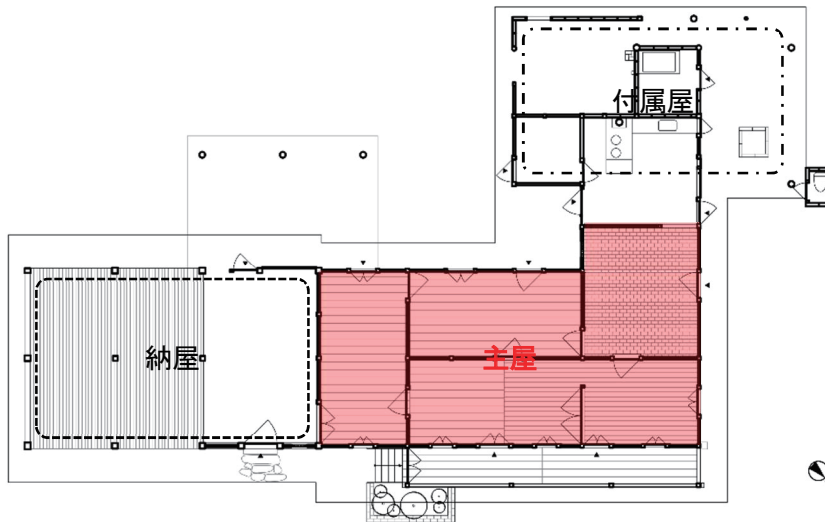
沖山剛造住宅の平面図と第二期の対象範囲（赤色内）
